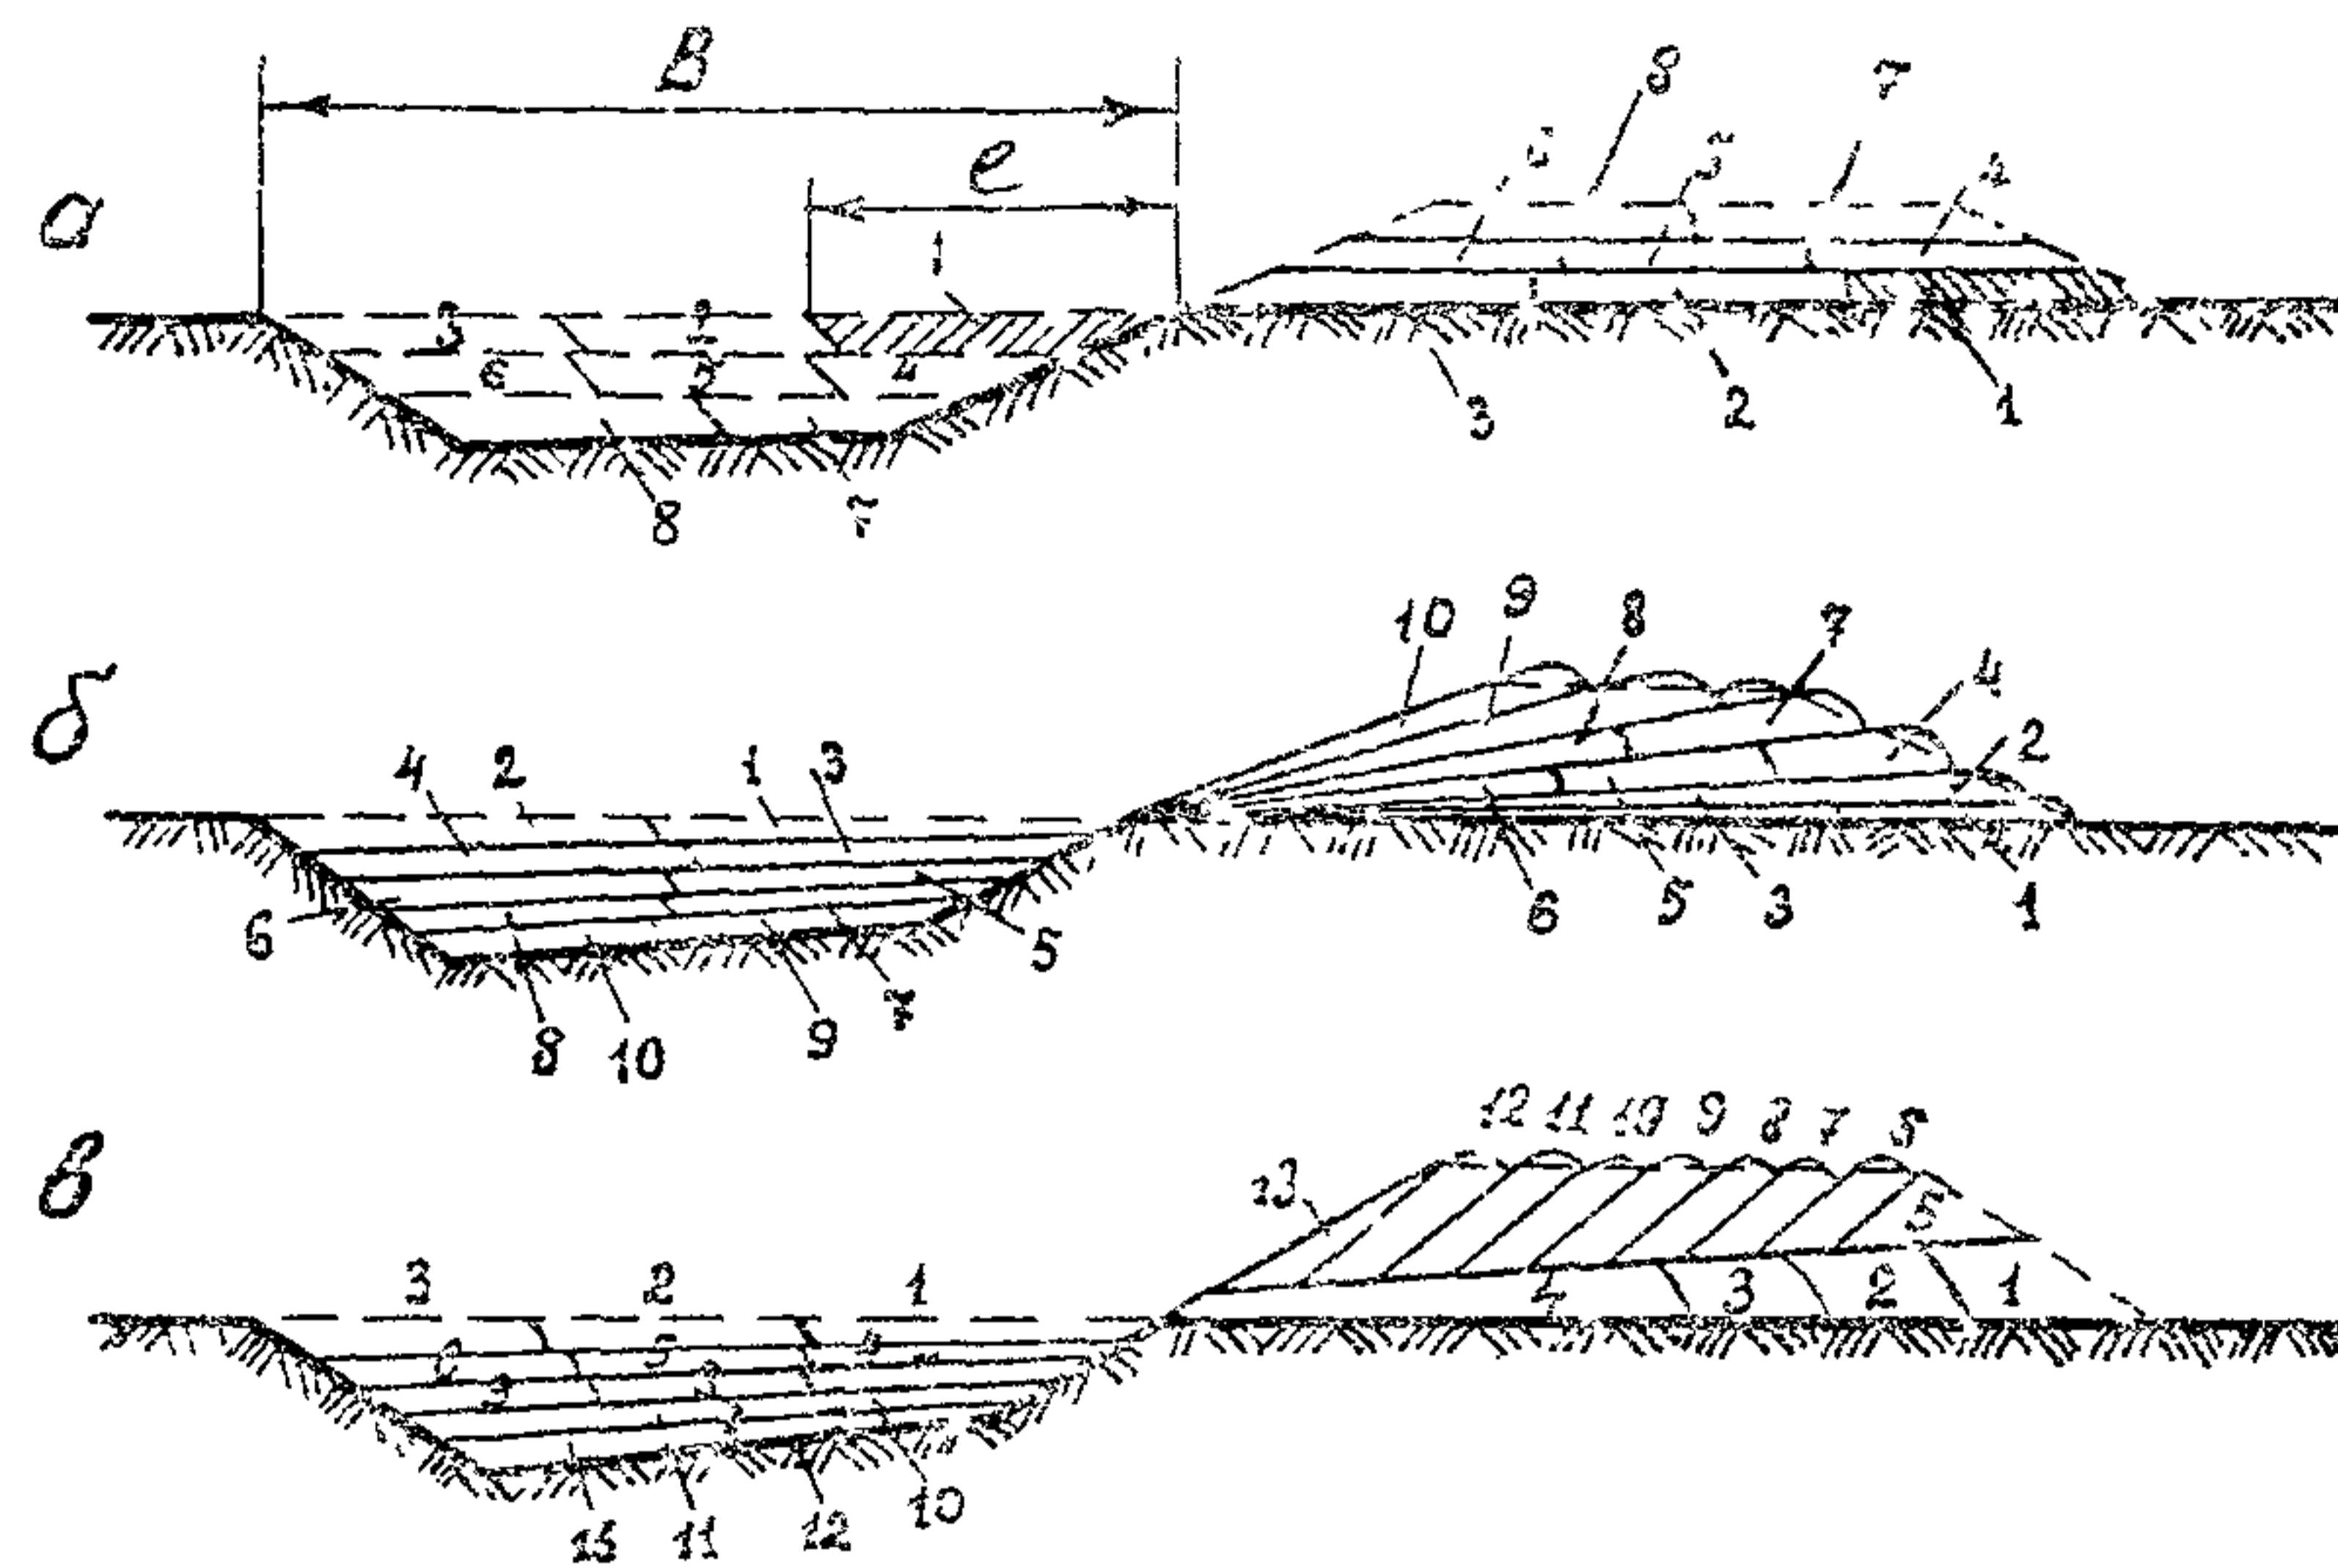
Схемы разработки одностороннего резерва и укладки грунта в насыпь:
